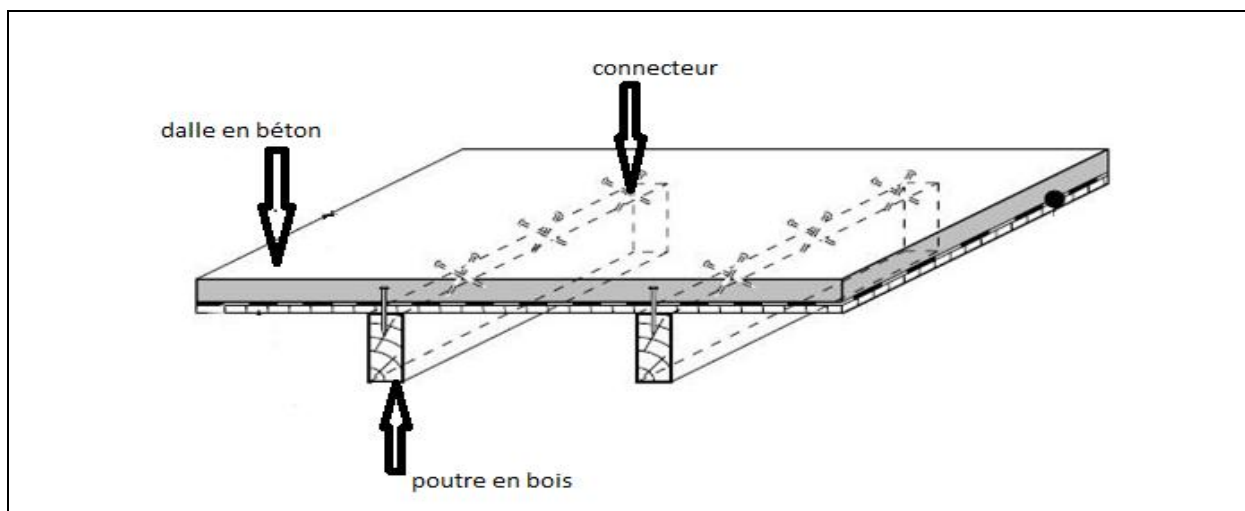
Schéma de principe d'un plancher mixte en bois-béton
